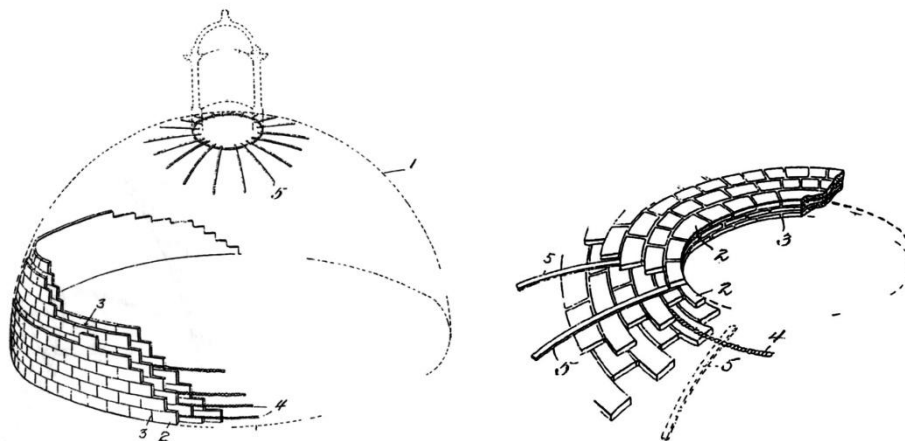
Sistema patentado por Rafael Guastavino Expósito de cúpulas tabicadas con armadura metálica para la resistencia de la zona traccionada. (R. Guastavino. Masonry Structure, Patented Jan. 18. 1910)
